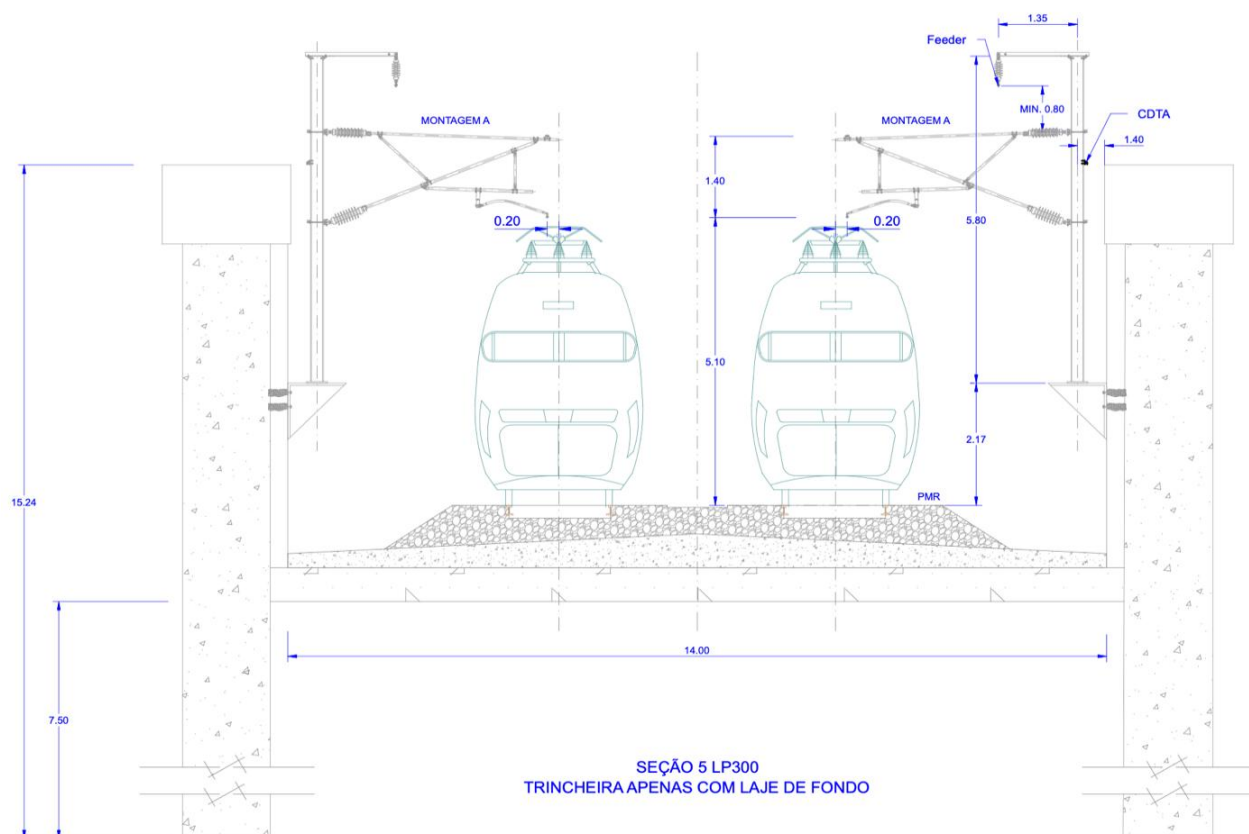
Perfil tipo da catenária em Trincheira apenas com laje de fundo
